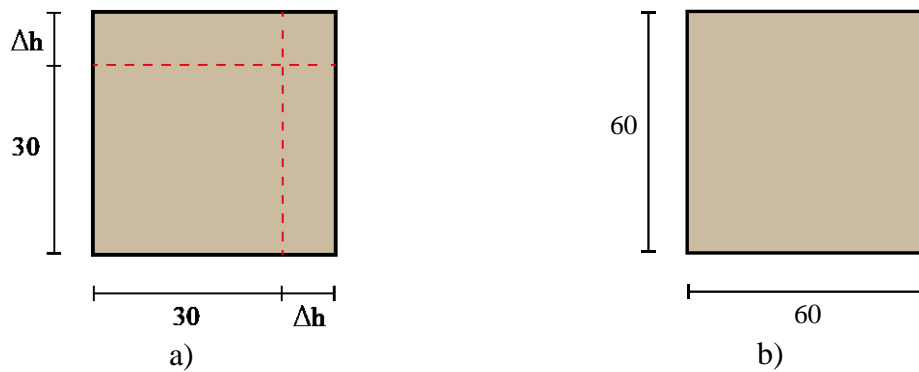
Columnas de concreto reforzado: a) incremento inicial de ancho de columna y b) columna con ancho final
